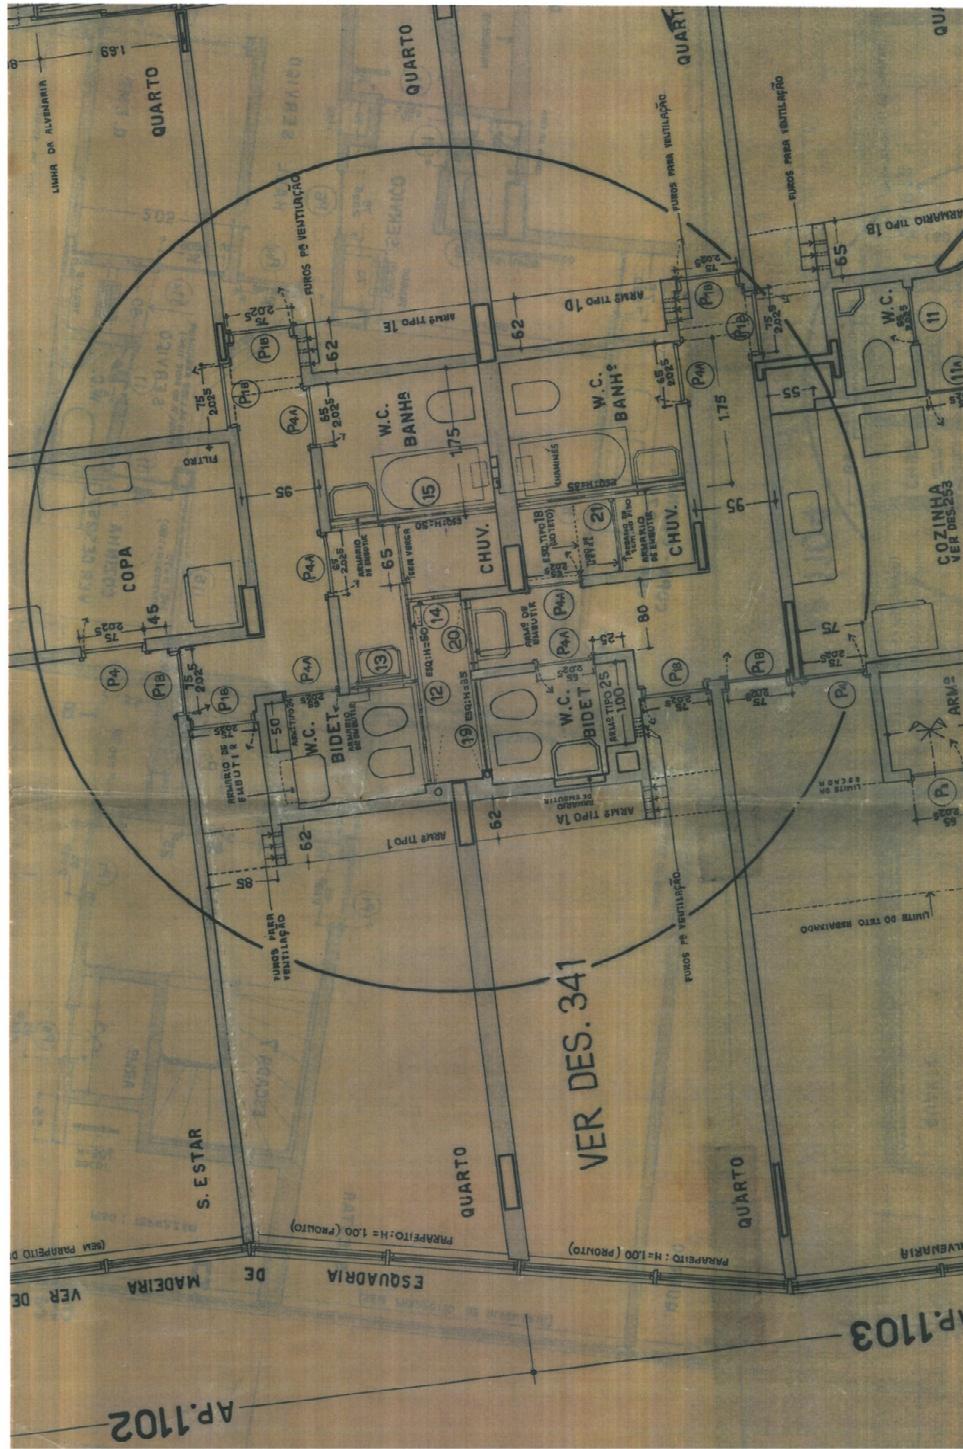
D – Planta baixa do pavimento tipo componente do projeto executivo
